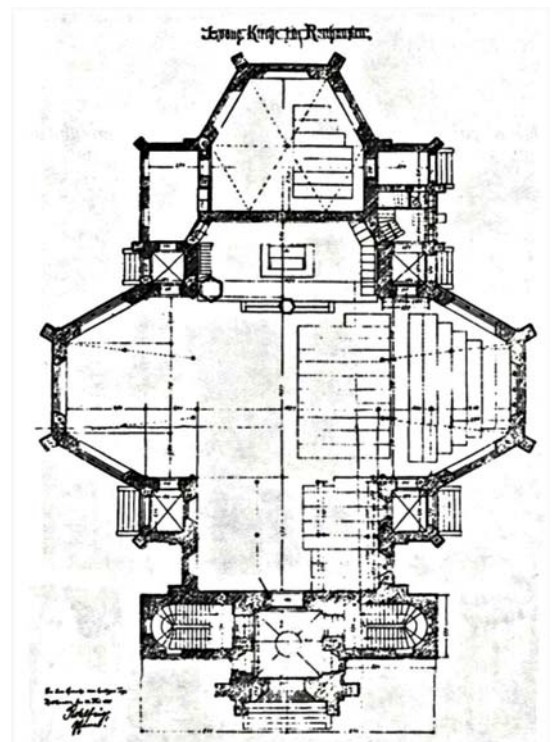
Grundriss Erd-/Emporengeschoss
